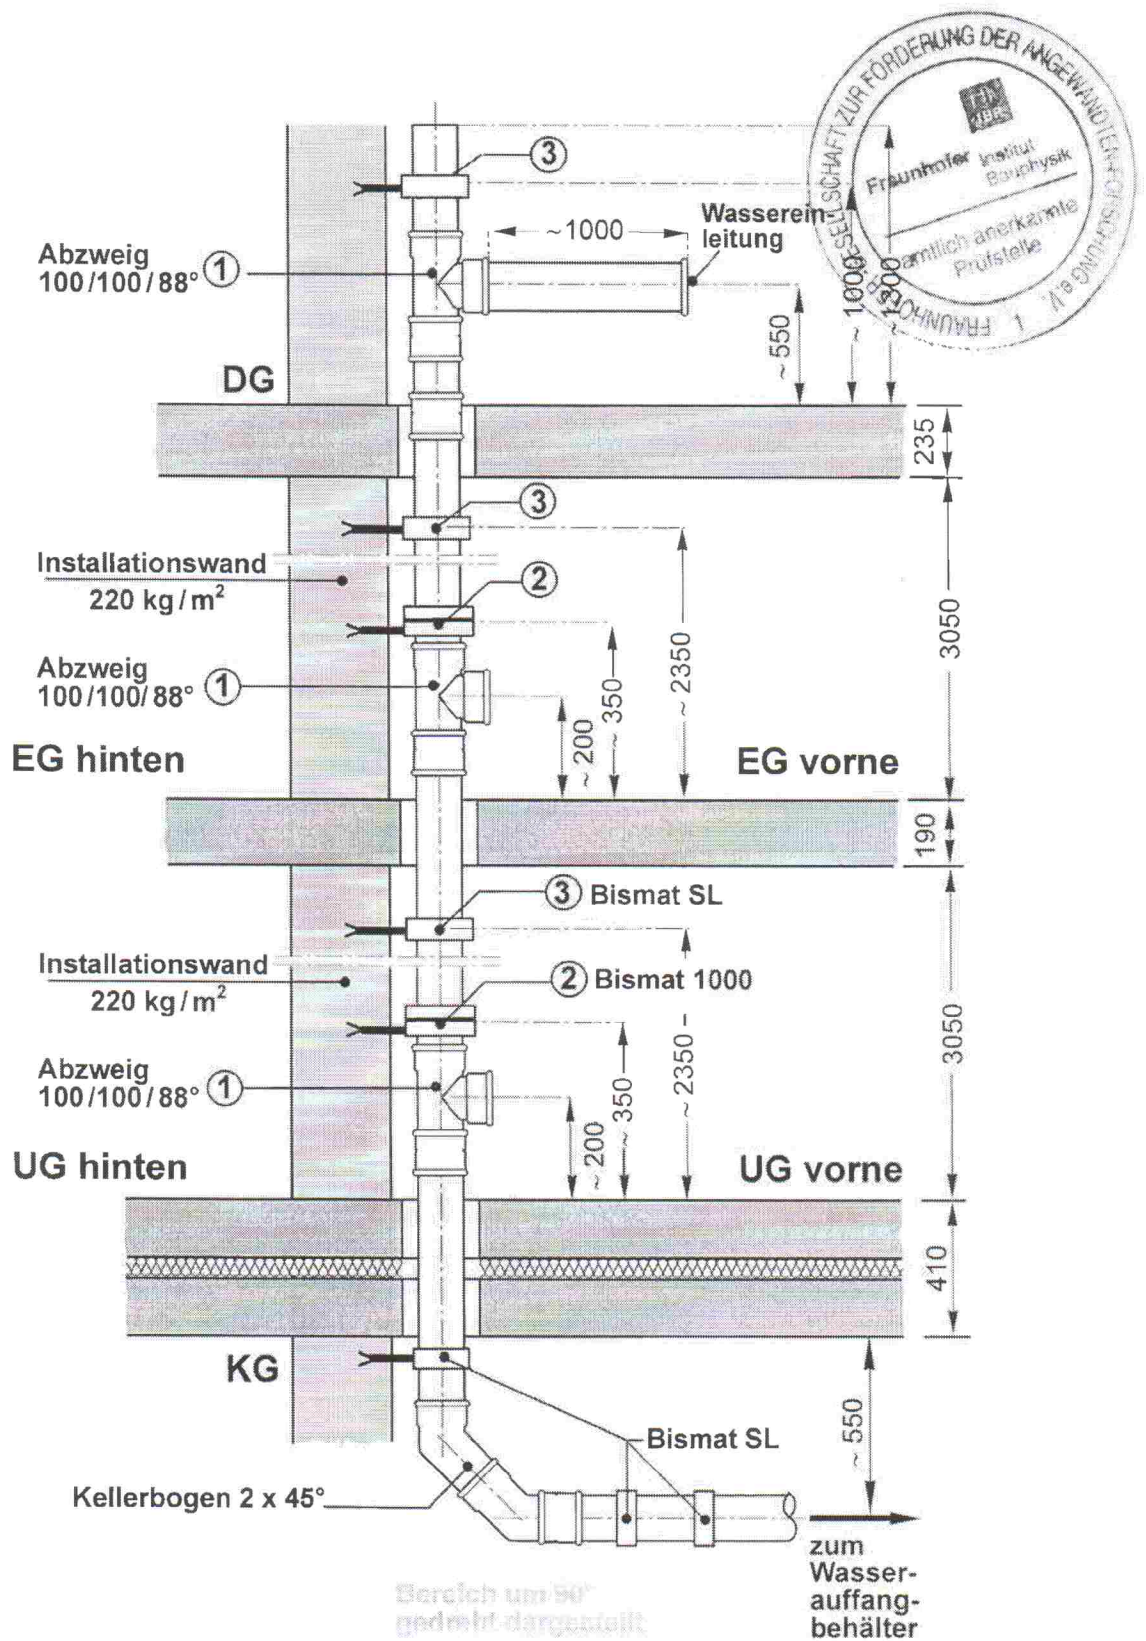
Installationsplan für das Abwassersystem "WAVIN AS" (OD 110) der Firma WAVIN mit Rohrschellen "Bismat 1000" (mit Abstandhalter) der Firma Walraven (Darstellung nicht maßstäblich, Maßangaben in mm).
